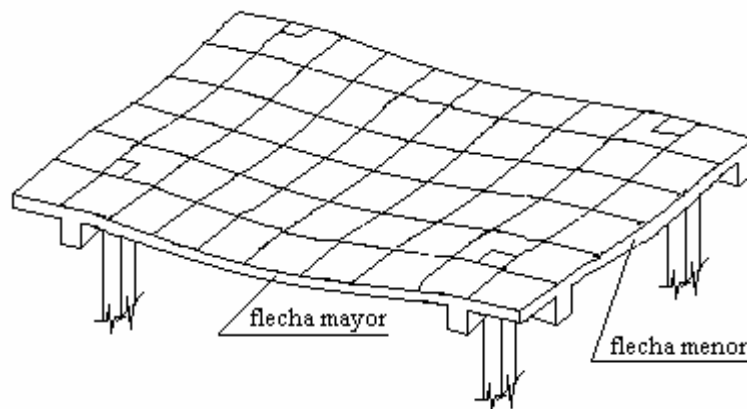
Deformación de losa reticular apoyada en vigas flexibles
